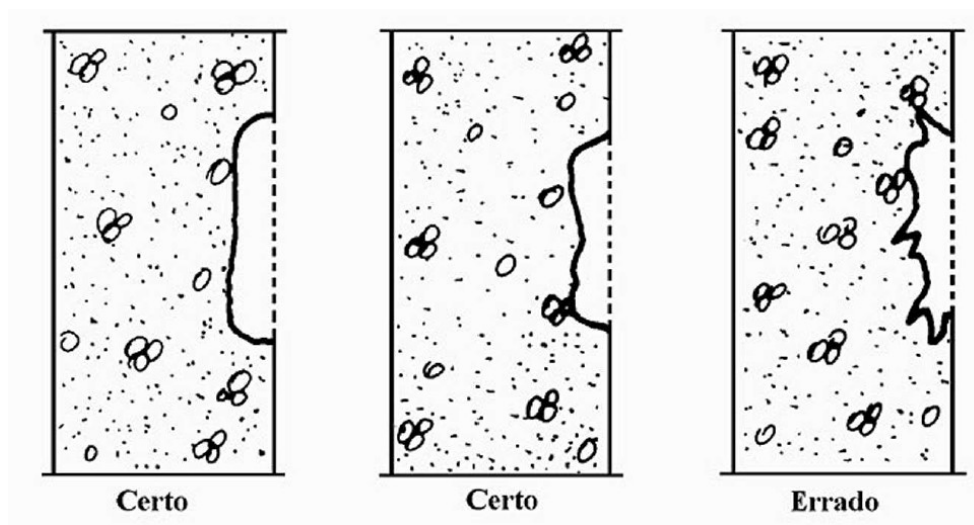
Aspecto final da cavidade na intervenção de corte de concreto
